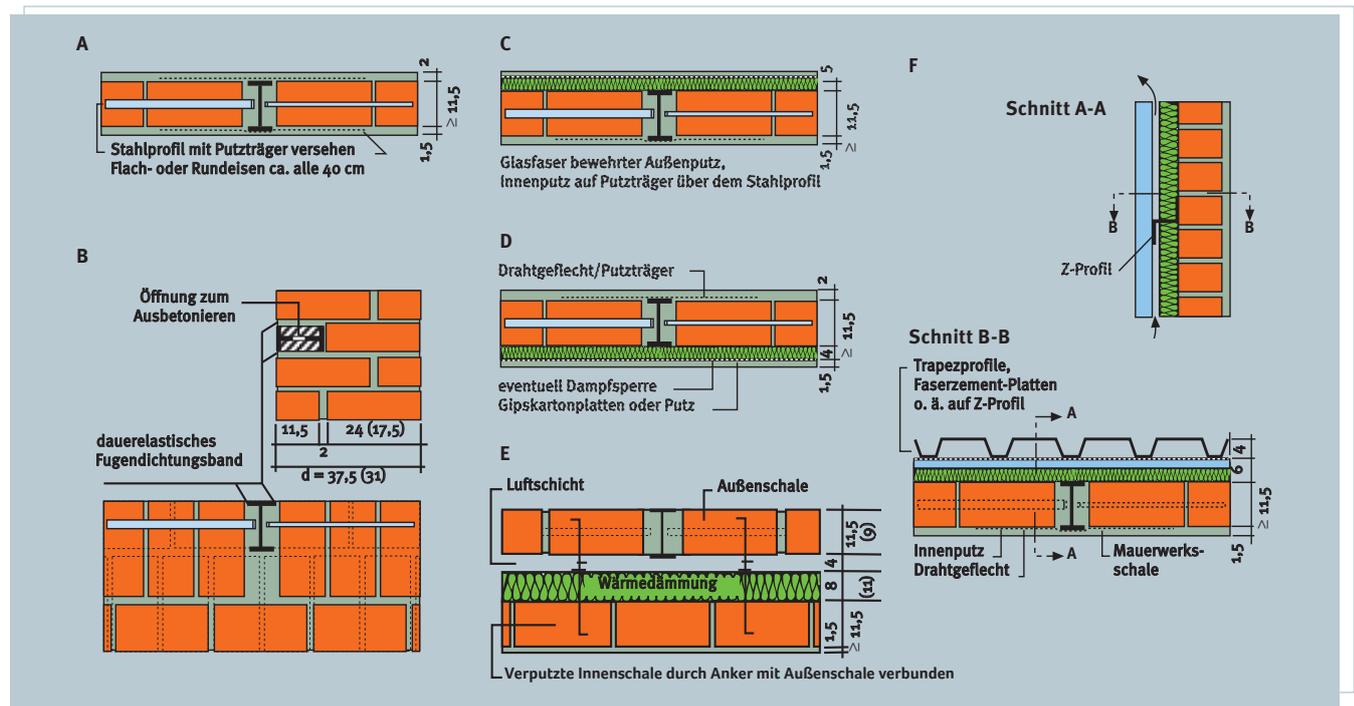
Mauerwerkswände im Hallenbau - Wandaufbau und konstruktive Details
